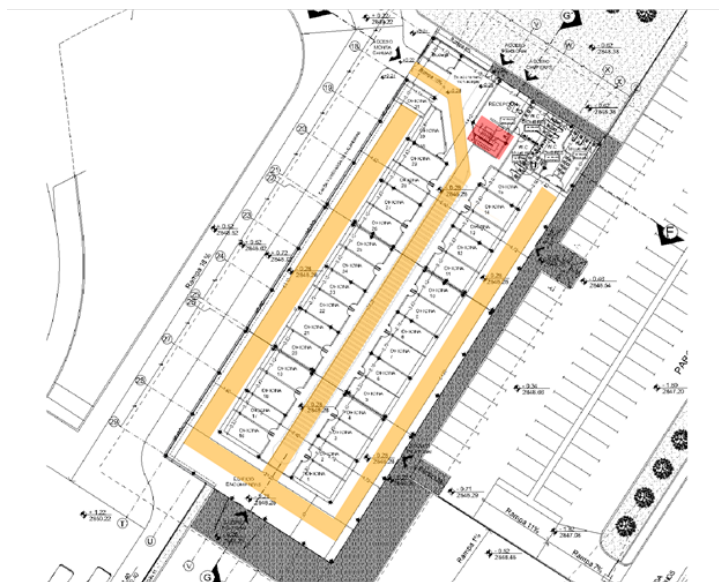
Circulación planta baja, segundo edificio del terminal sur de Ambato.
